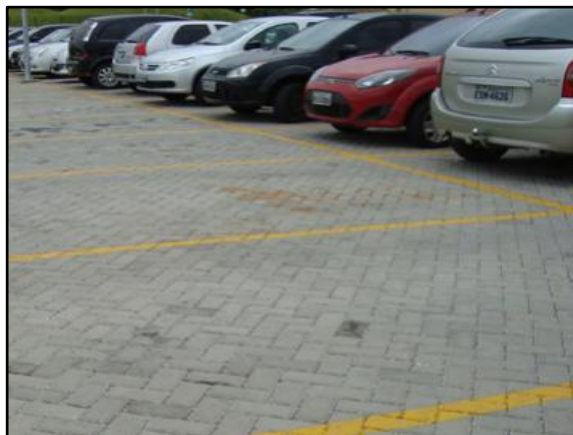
Pavimento poroso – piso intertravado instalado em passeio público
